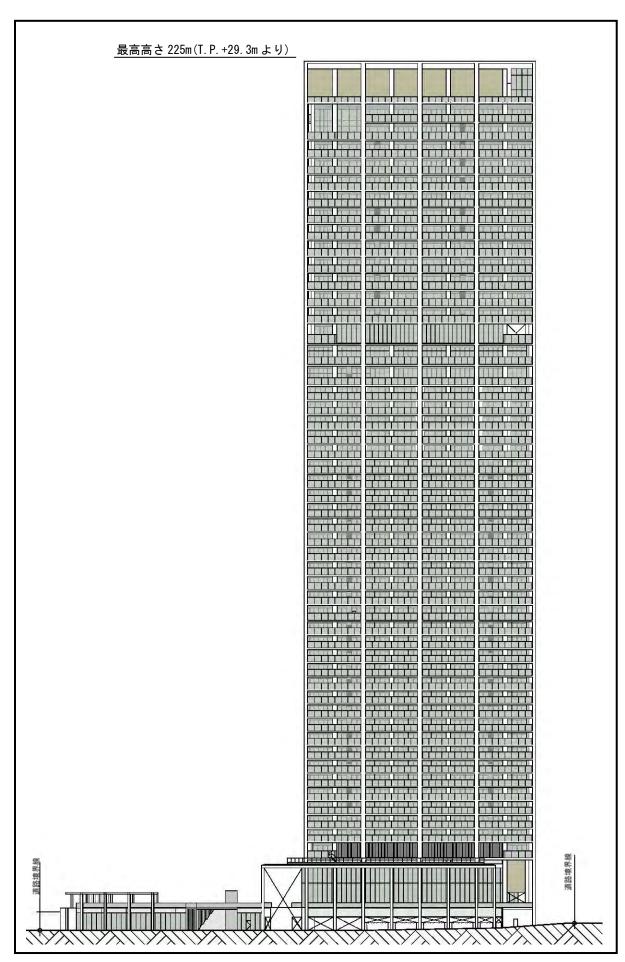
(2) 立面図 (東立面図 S=1:1,000)
